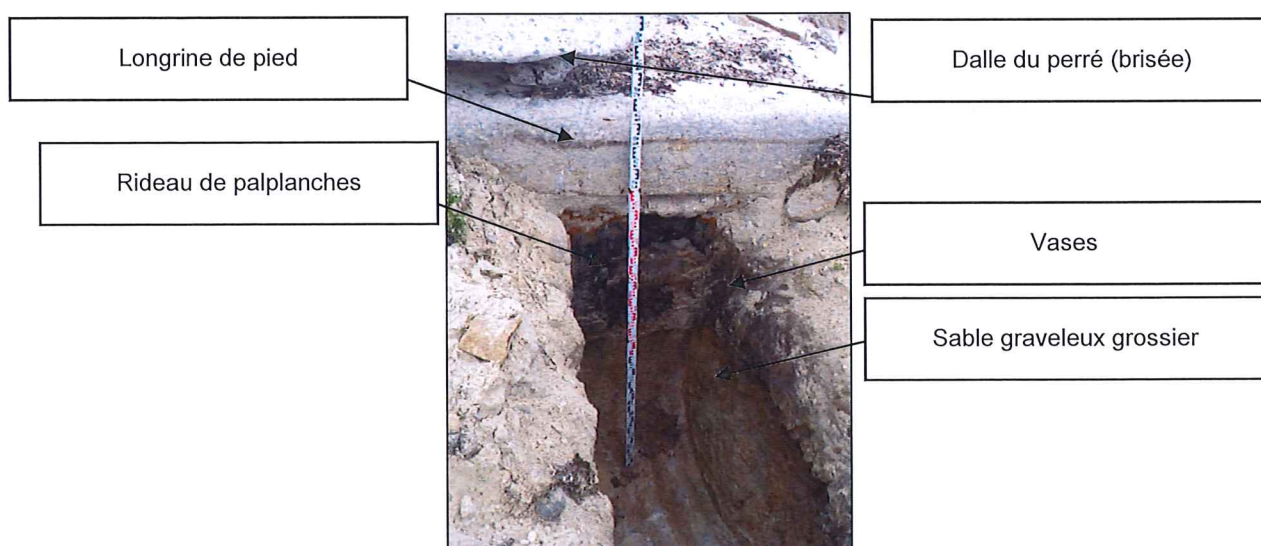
Pied d'ouvrage observé au droit du sondage P3 (Source : Arcadis)
